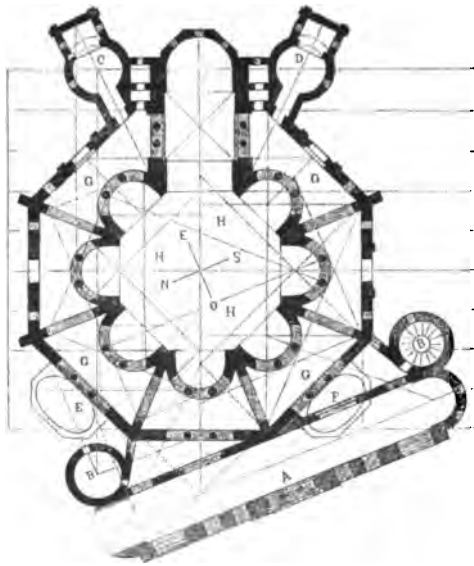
Grundriss von S. Vitale in Ravenna.
